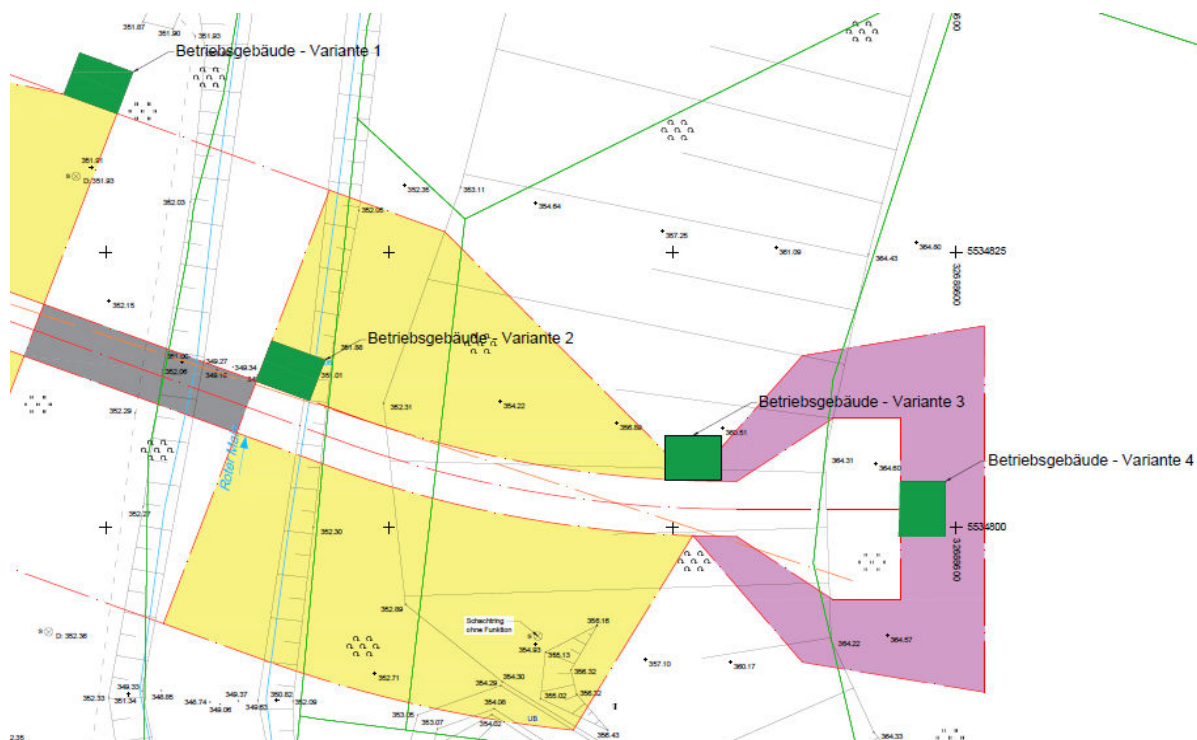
Mögliche Standorte für Betriebsgebäude
